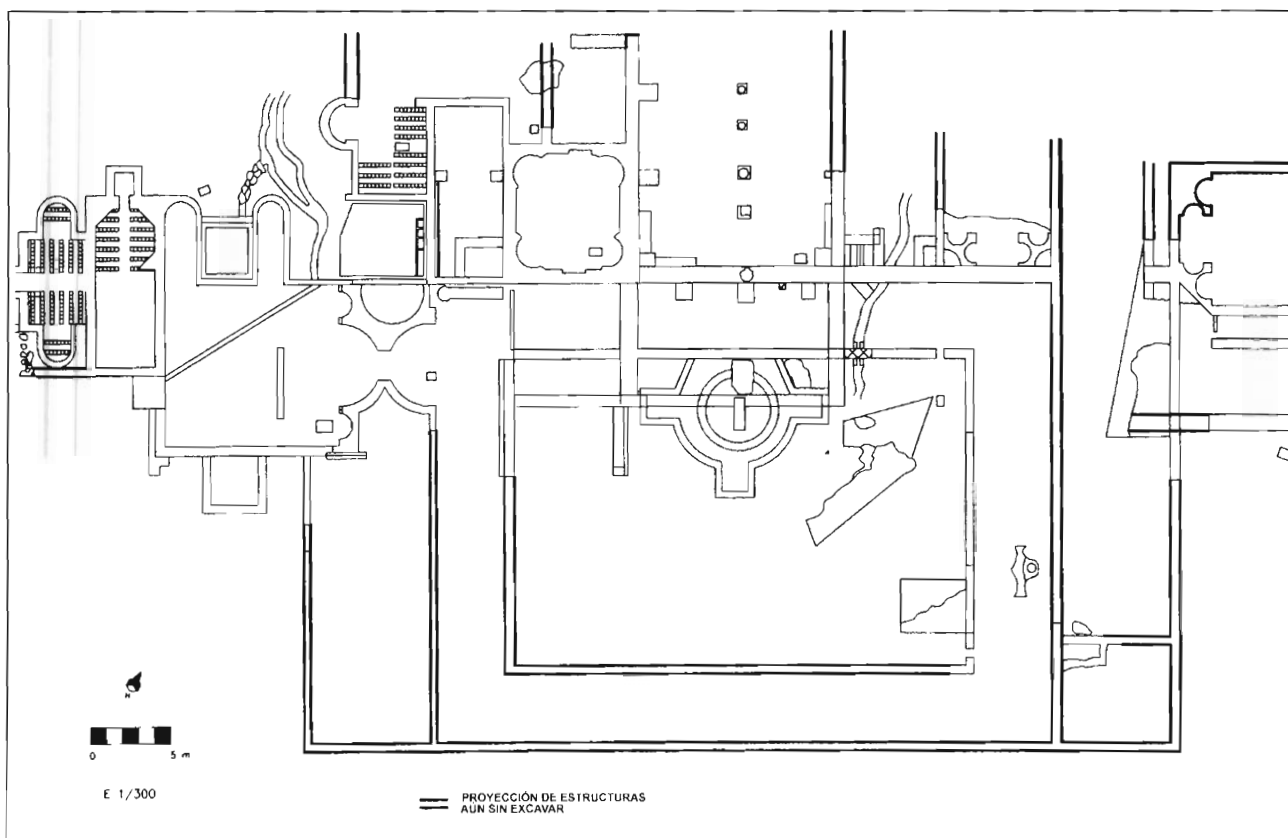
Plano con la proyección de estructuras arquitectónicas.
